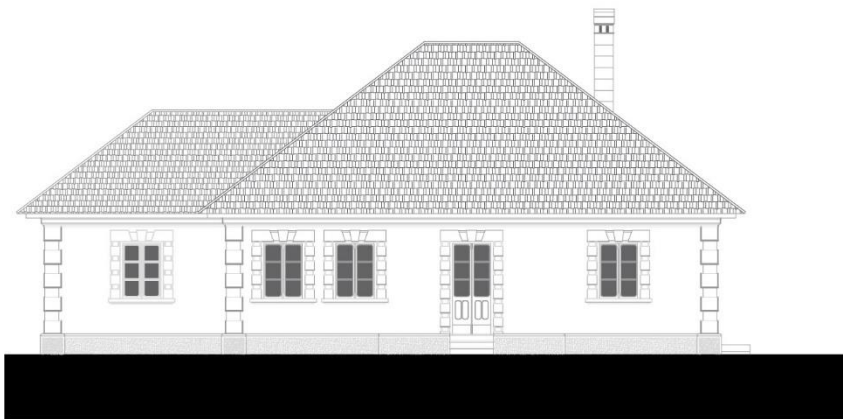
Fachada oeste. Situação atual (2017).
